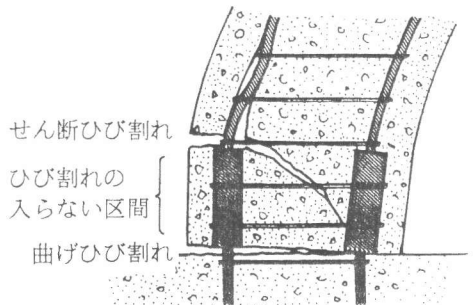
スリーブ継手を有するPCa部材のひび割れパターン
